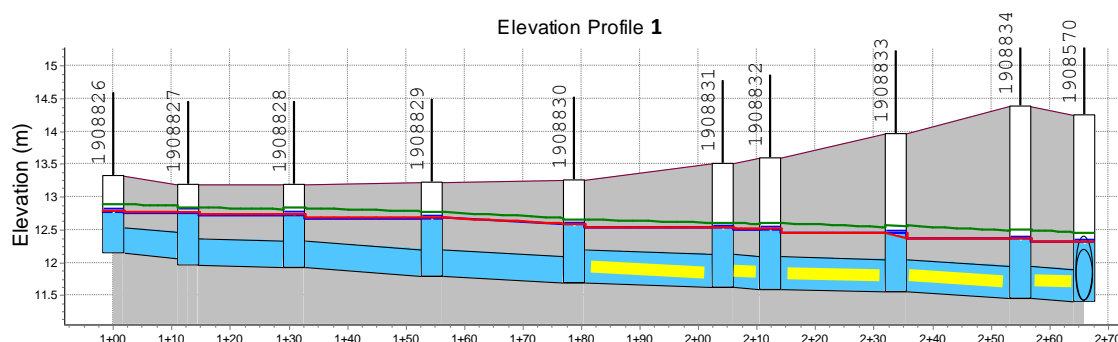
Perfil del tramo intervenido de la zona Z1
